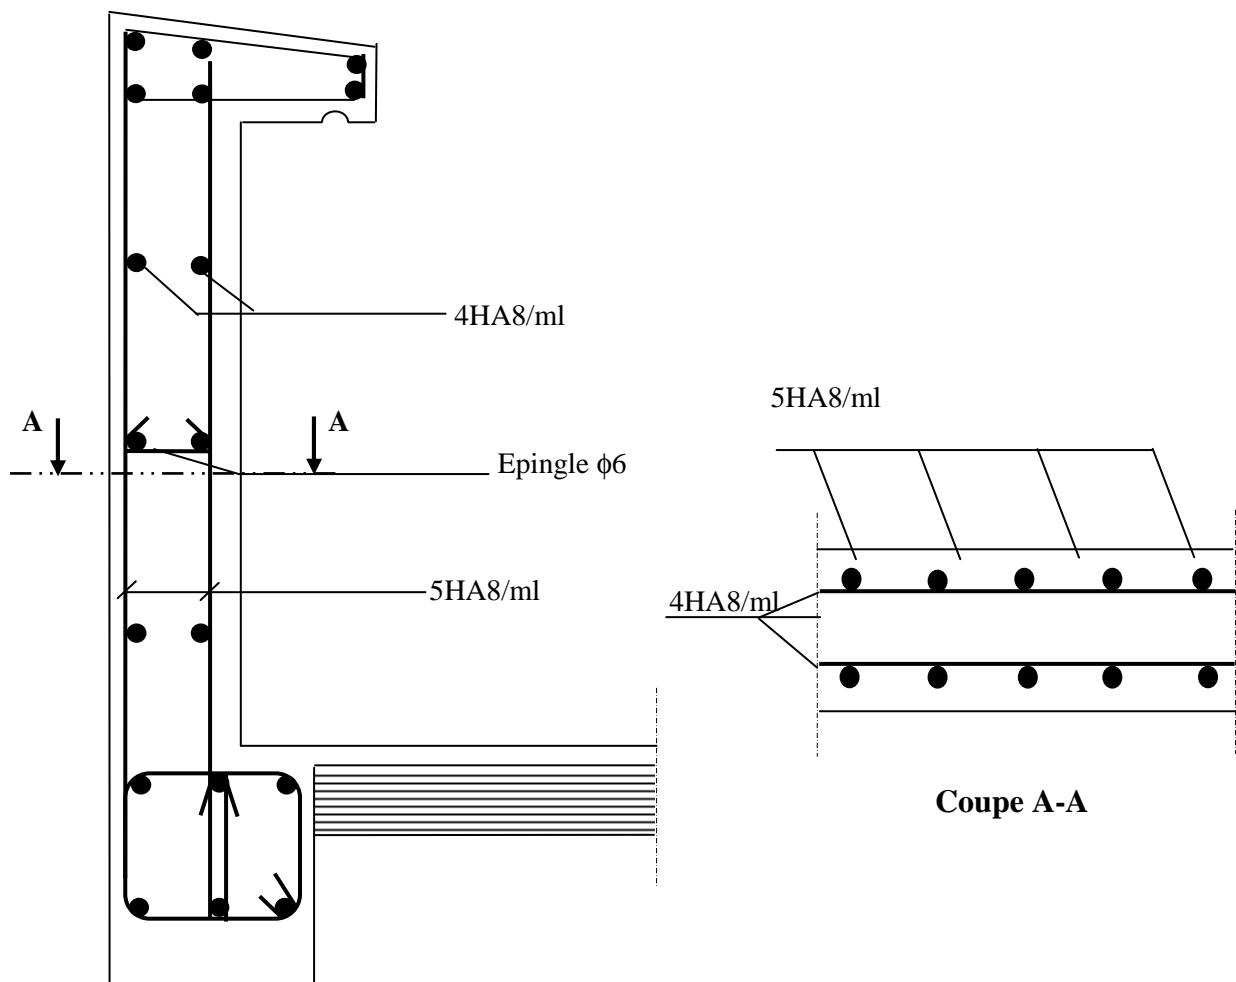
Plan de Ferrailage de l'acrotère.
